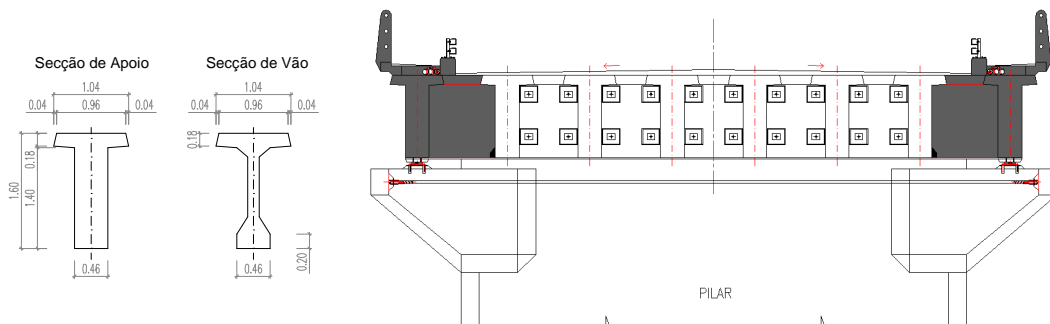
Novas vigas e perfil transversal sobre o pilar após alargamento
